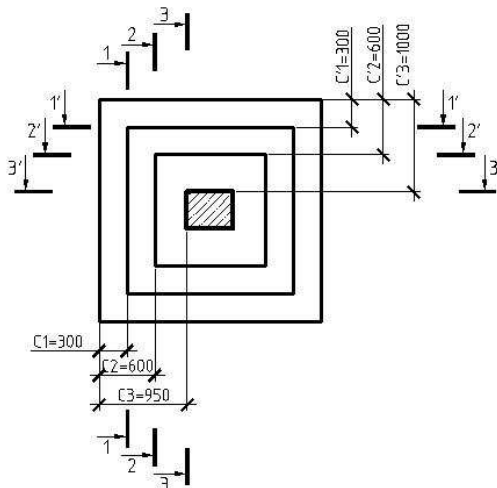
Схема к расчету арматуры плитной части фундамента
